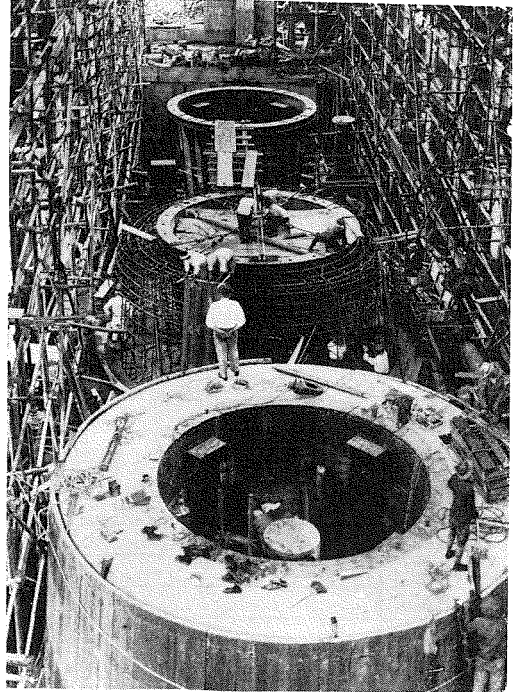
発電所内水車据付の光景(3) 第一ランナー据付、コンクリートパレル施工 第二コンクリートパレル鉄筋組立中、第三パレルランナー据付完了、建家は三段目のコンクリート施工済。
